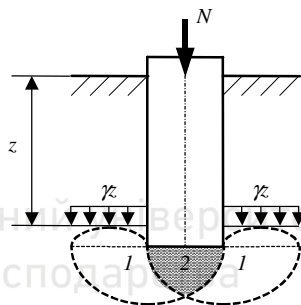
Схема руйнування основи під фундаментом глибокого закладання:
